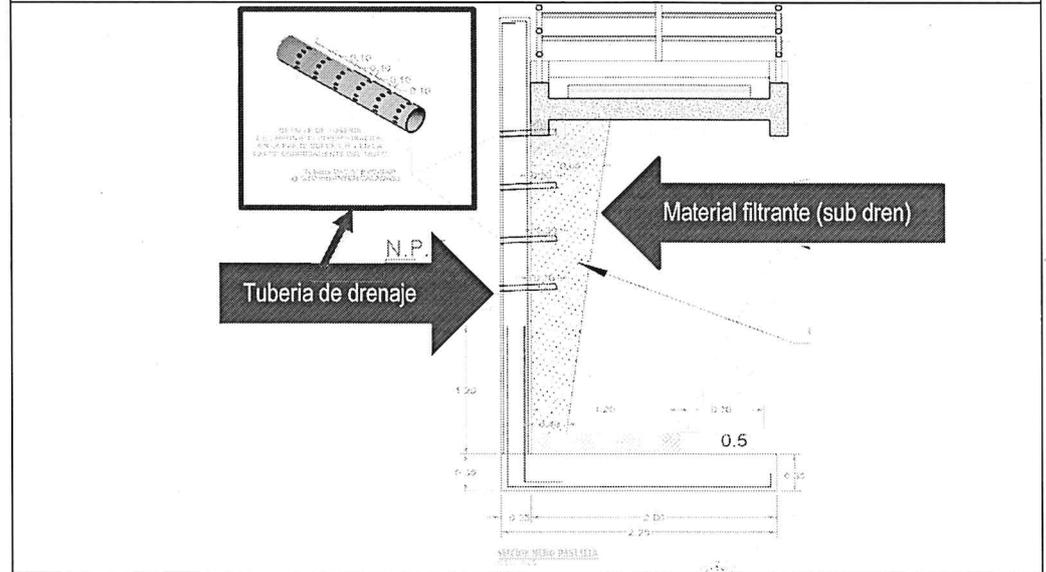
Detalles de la tubería de drenaje y los detalles del material filtrante.
